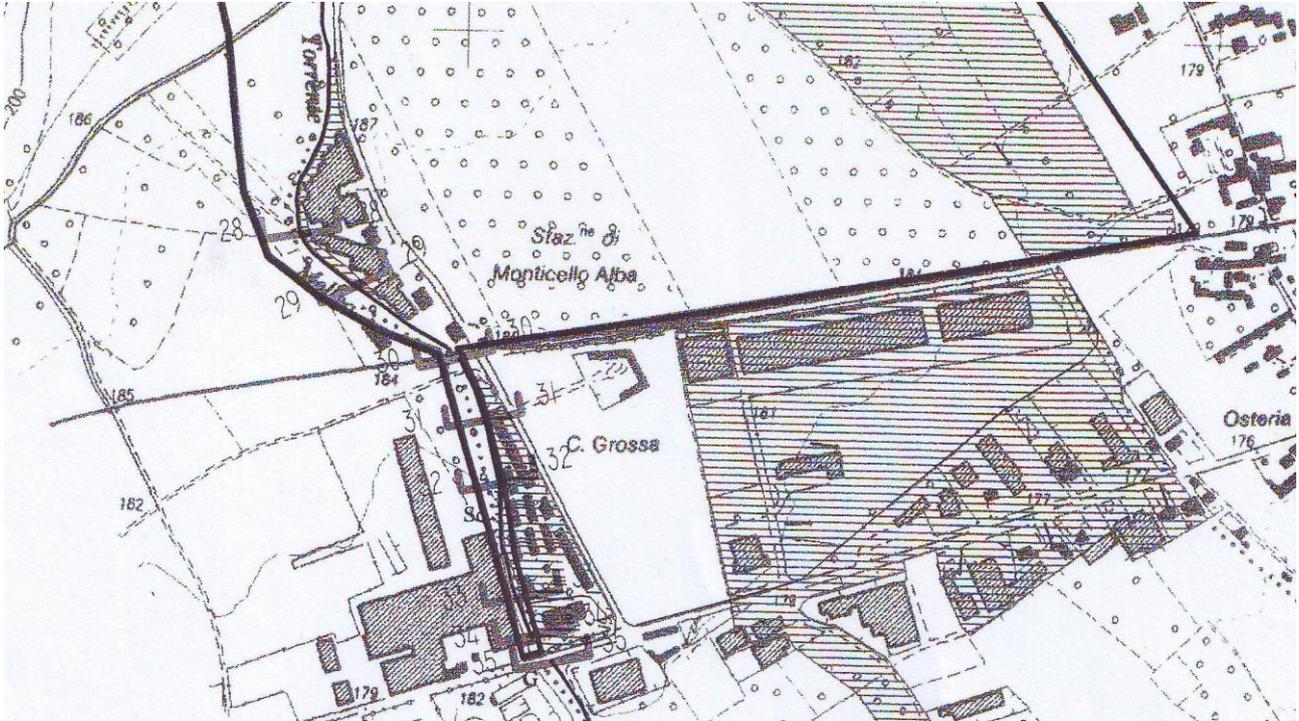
Planimetria e sezioni 29 e 30 dell'area interessata dalla nuova SSE
